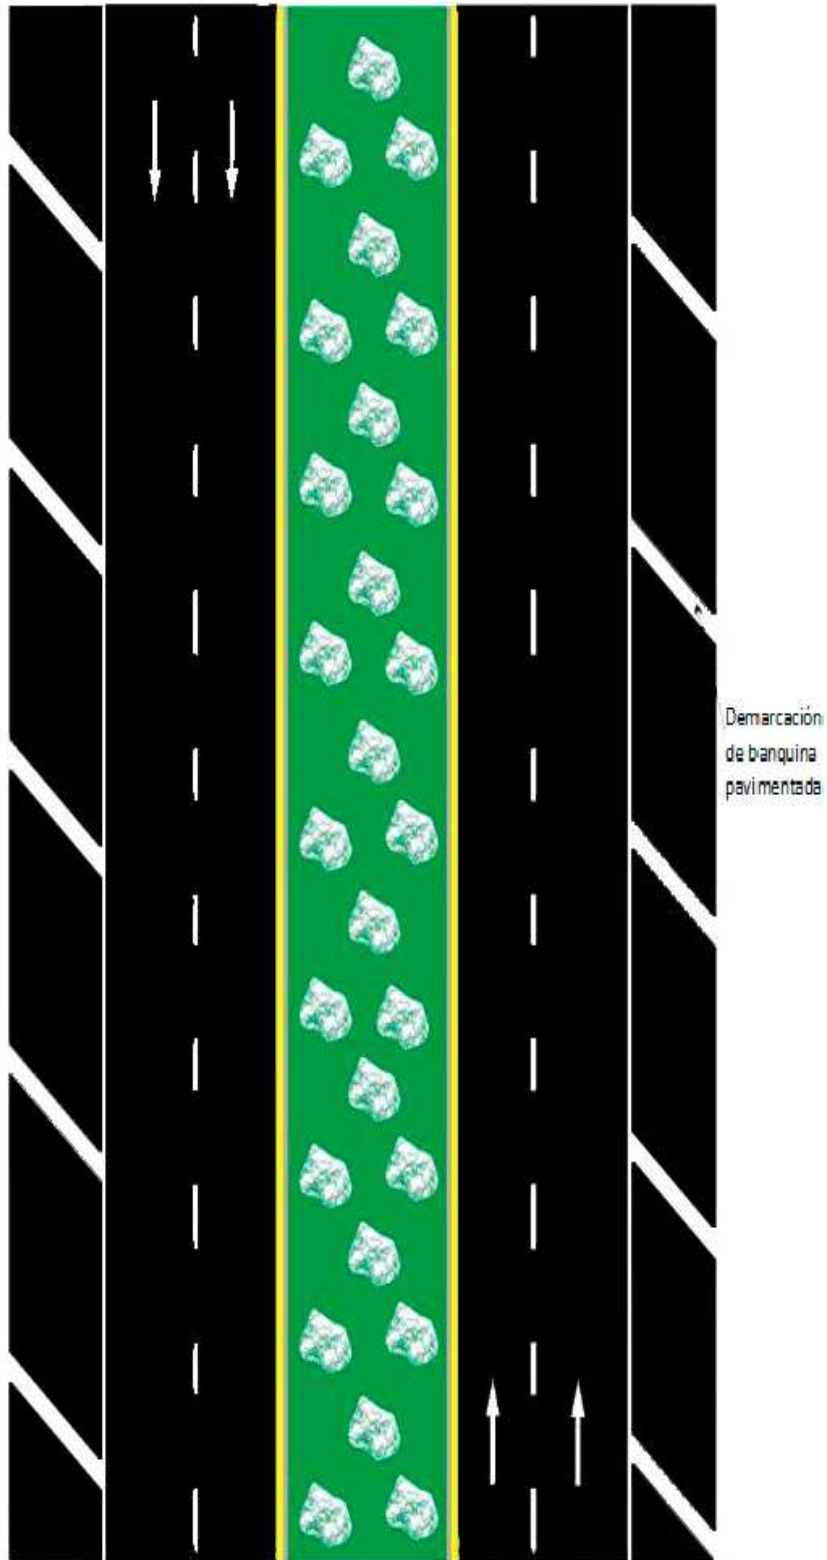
11. DEMARCACIÓN DE BANQUINAS PAVIMENTADAS
